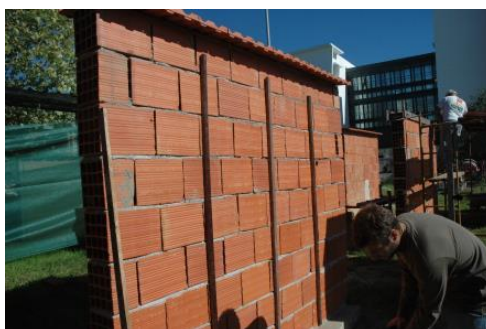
Murete dividido antes da aplicação das argamassas
